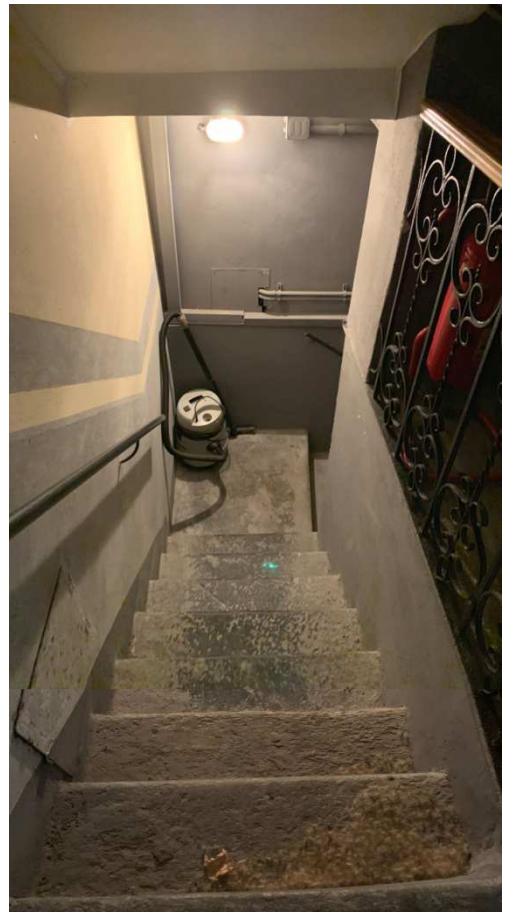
Piano Interrato. Vano scala condominiale e piano cantinato
